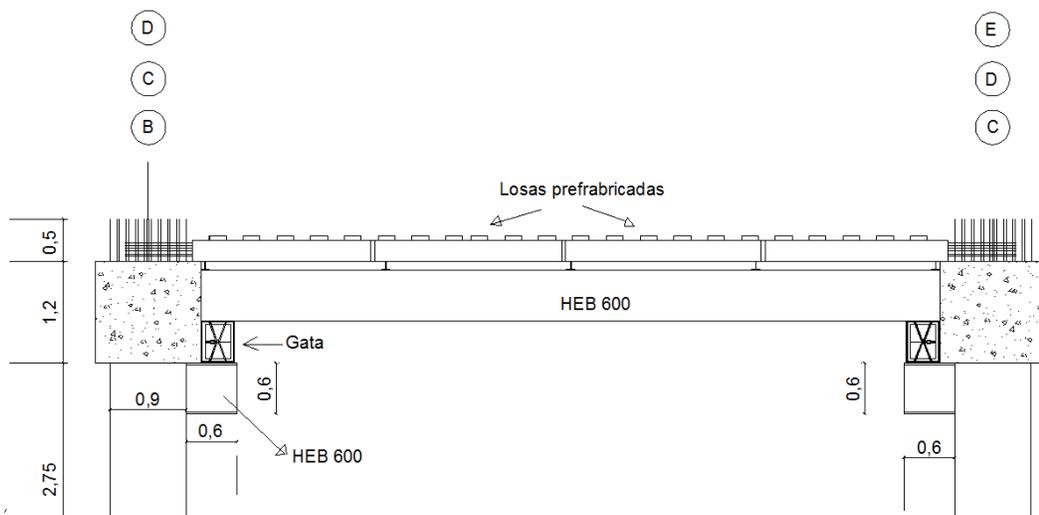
Losa prefabricadas sobre apoyo de perfiles HEB 100
